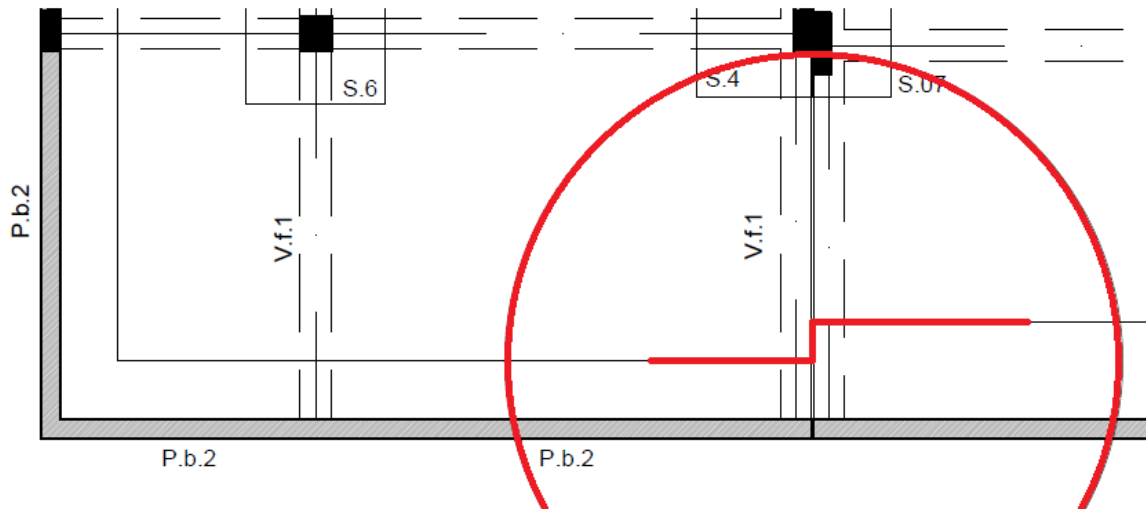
Planta anexa ao pedido de esclarecimento.
